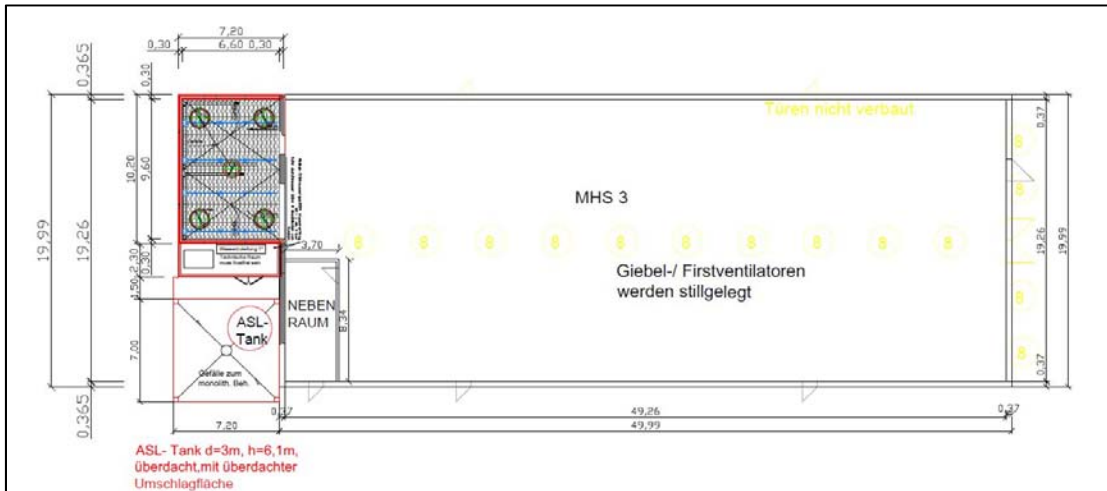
Ausschnitt aus den Planunterlagen, Grundriss MHS 3
